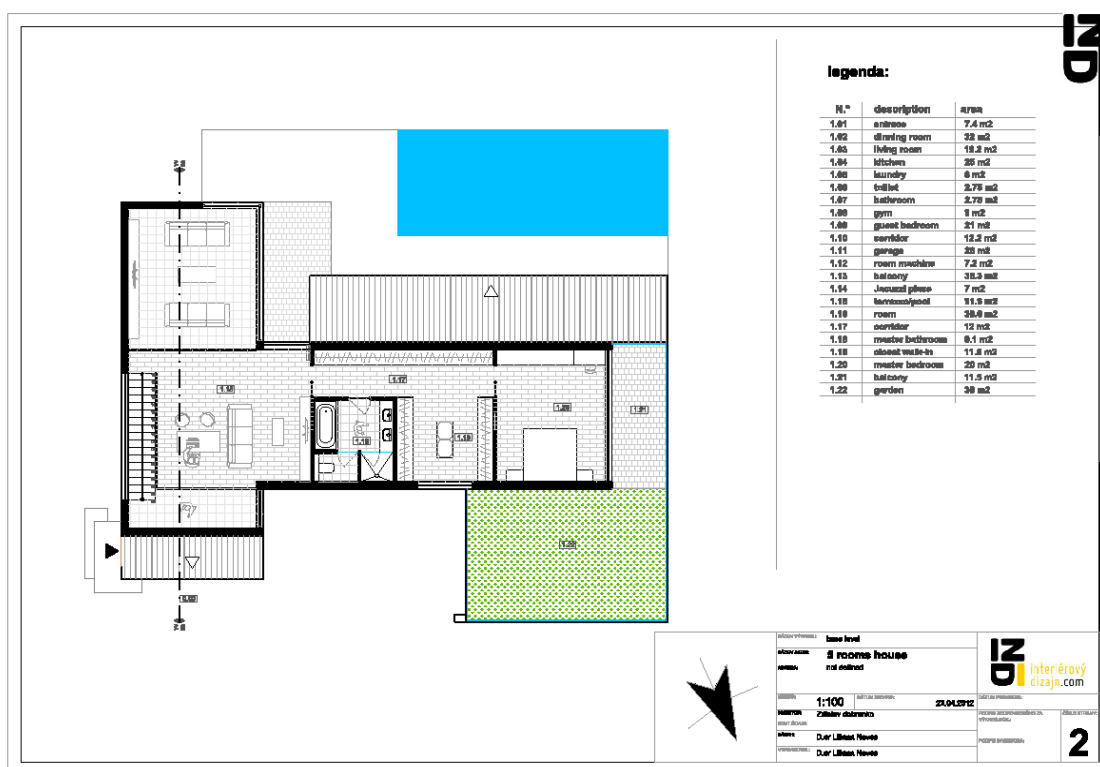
Zdislav and Maria house - planta de apresentação 1º andar
